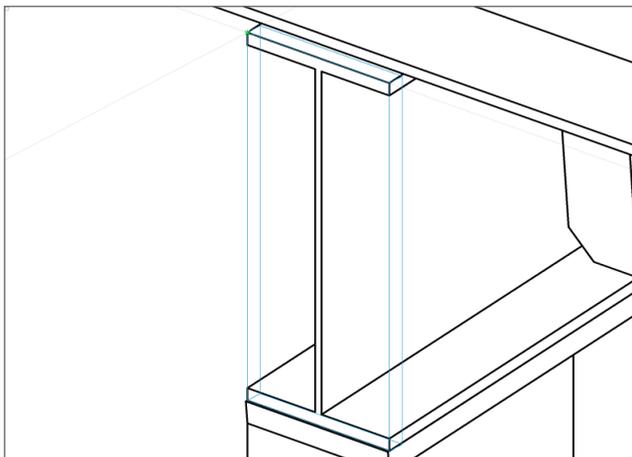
Eingabewerkzeug „An Profilbauteil“ - Vorschau
